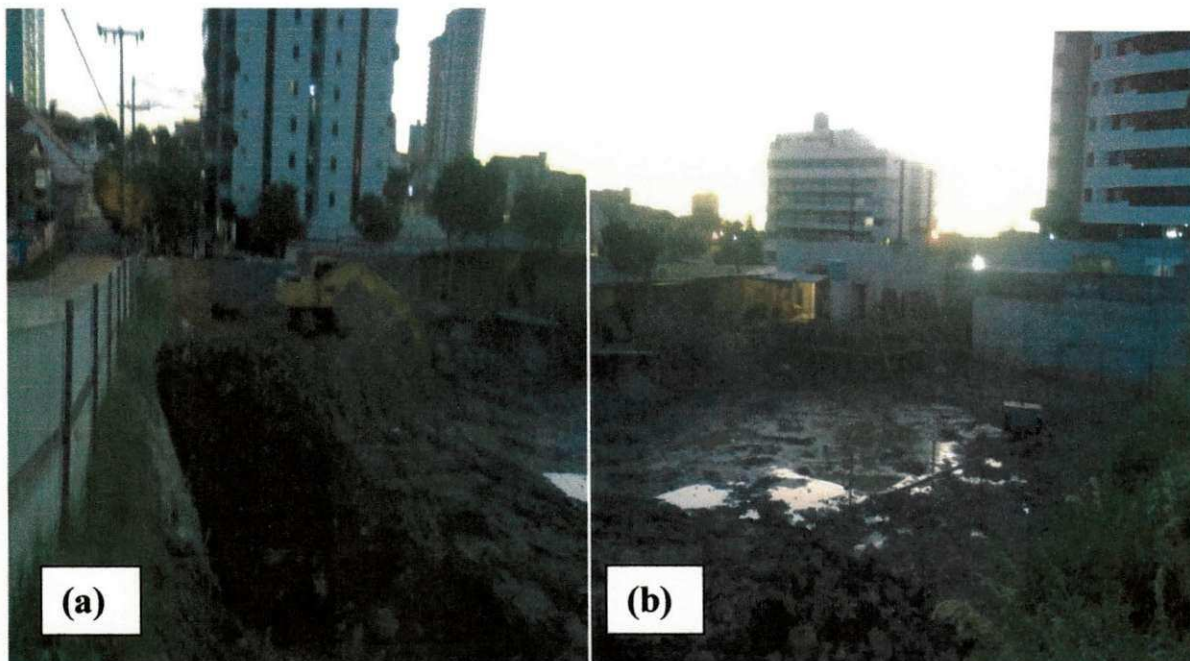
Fotos mostrando escavações das fundações (a) e paralisação das escavações devido às chuvas (b).
